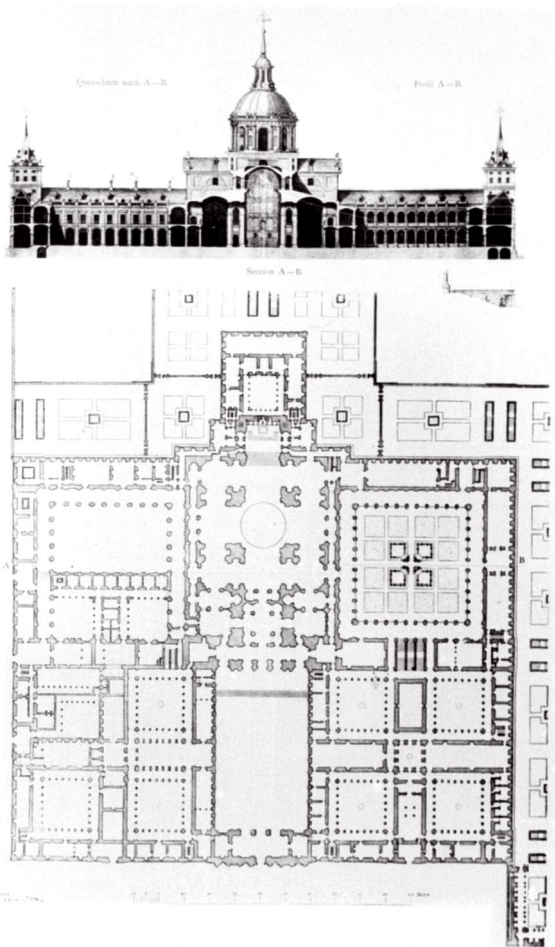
San Lorenzo del Escorial: Grundriss und Schnitt. Quelle: Bildindex, Neg.-Nr. 1.081.686
